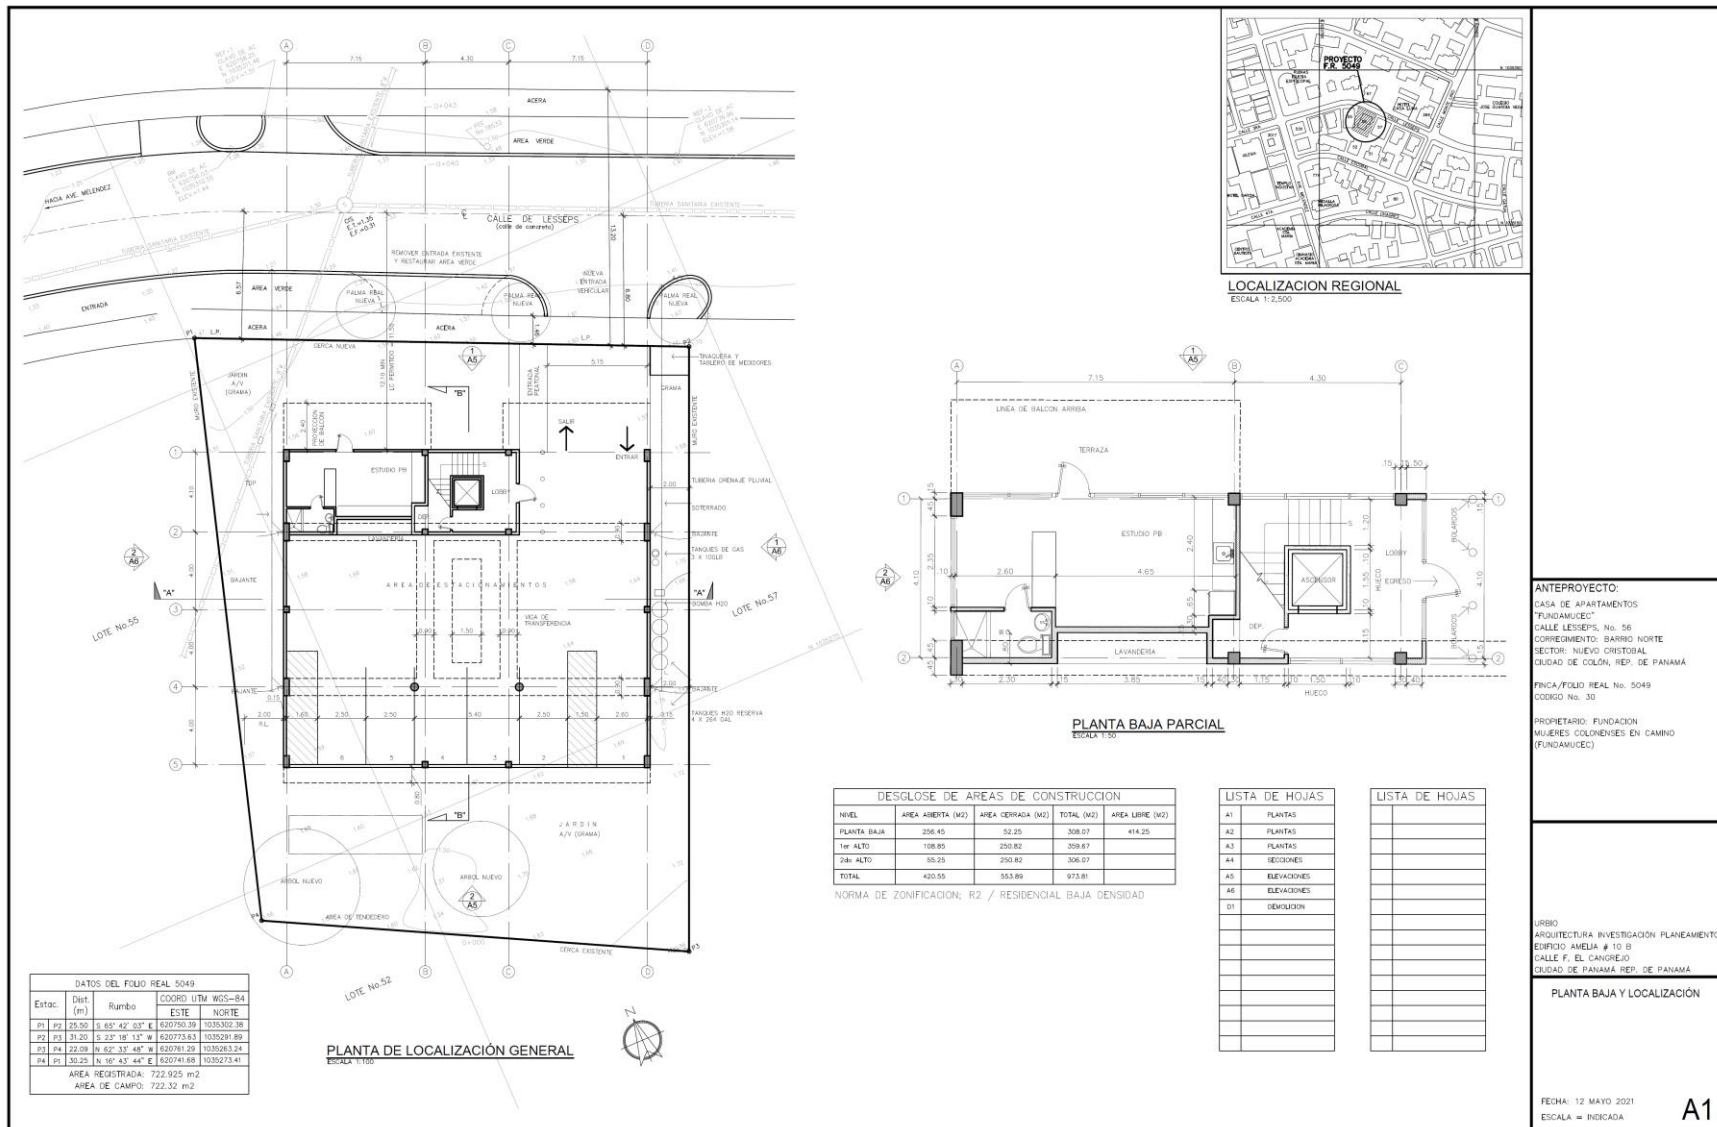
Vista general de la Planta arquitectónica. (ver en anexos para más detalle).
